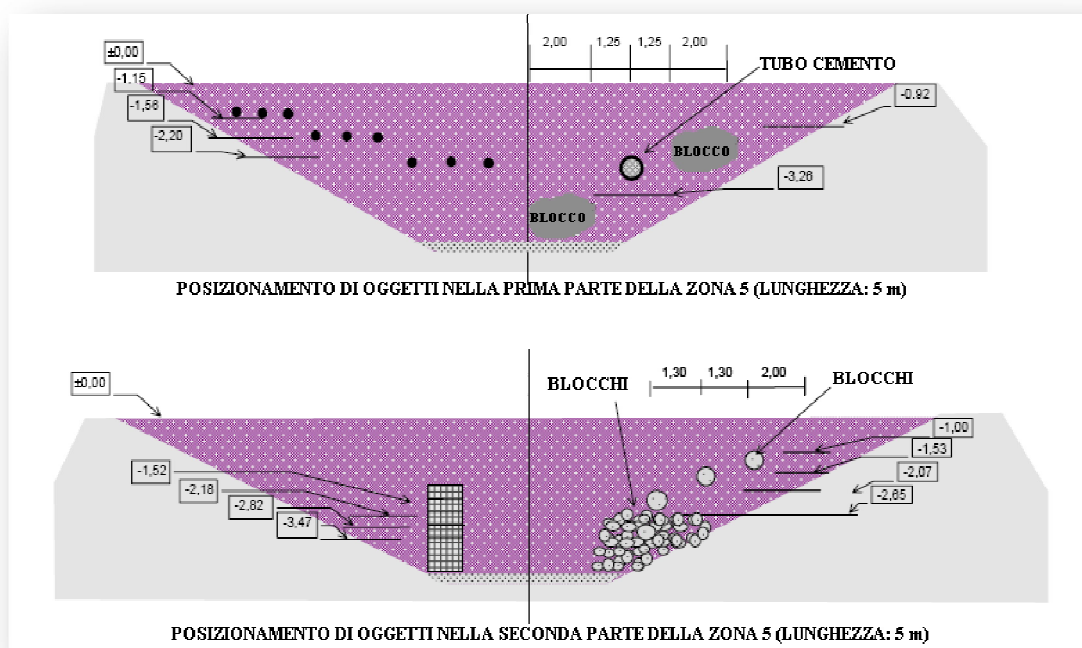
Sezione della zona 5 contenente ghiaia 0/20
